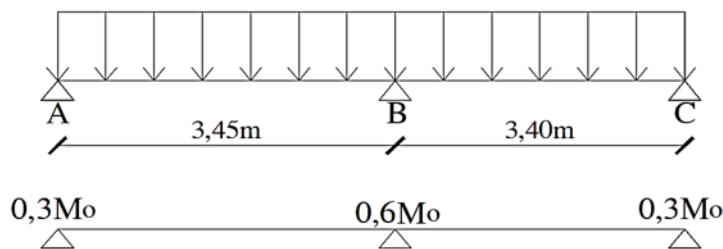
Schéma statique de la poutrelle à plusieurs travées de la poutre « II »
